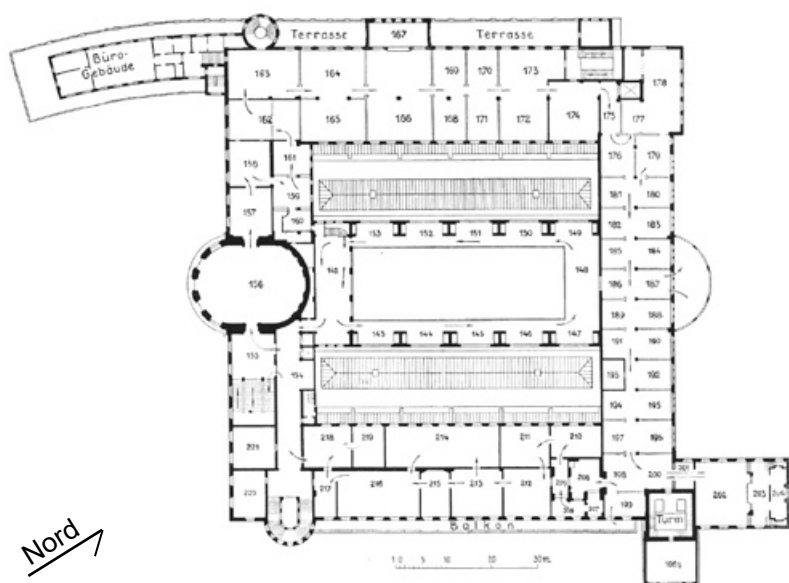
Grundriss des 1. OG (Matschoß 1933, S. 57).
